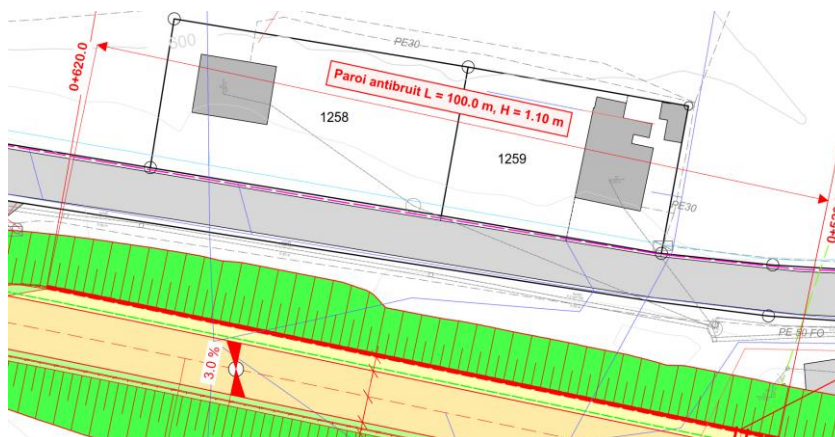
Extrait de situation du mur km 0+520 - 0+620
